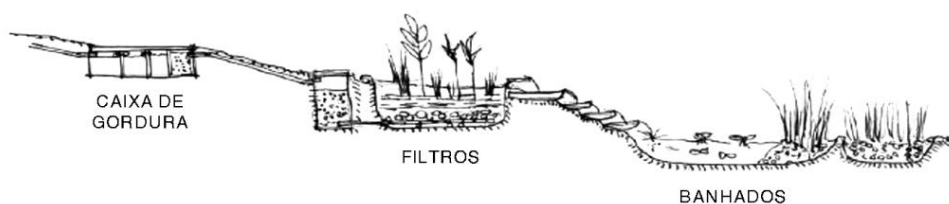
Filtragem da água com sistema de plantas (AVILA, 2008).
